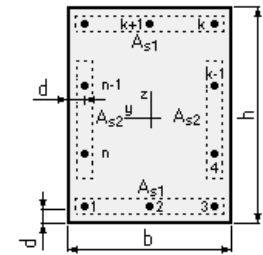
Disposition générale des armatures sur les poteaux
